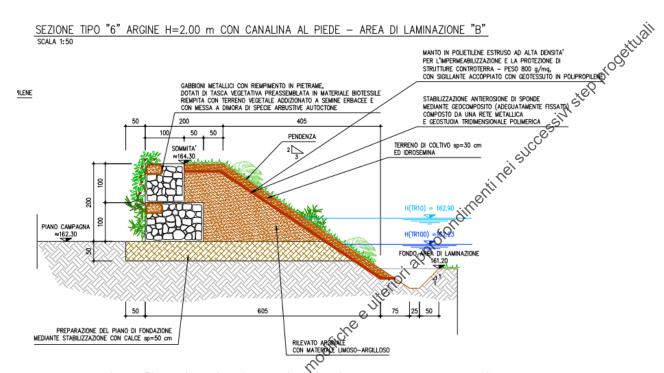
sezione tipo 6, area di laminazione B. Estratto da Tav. 10
